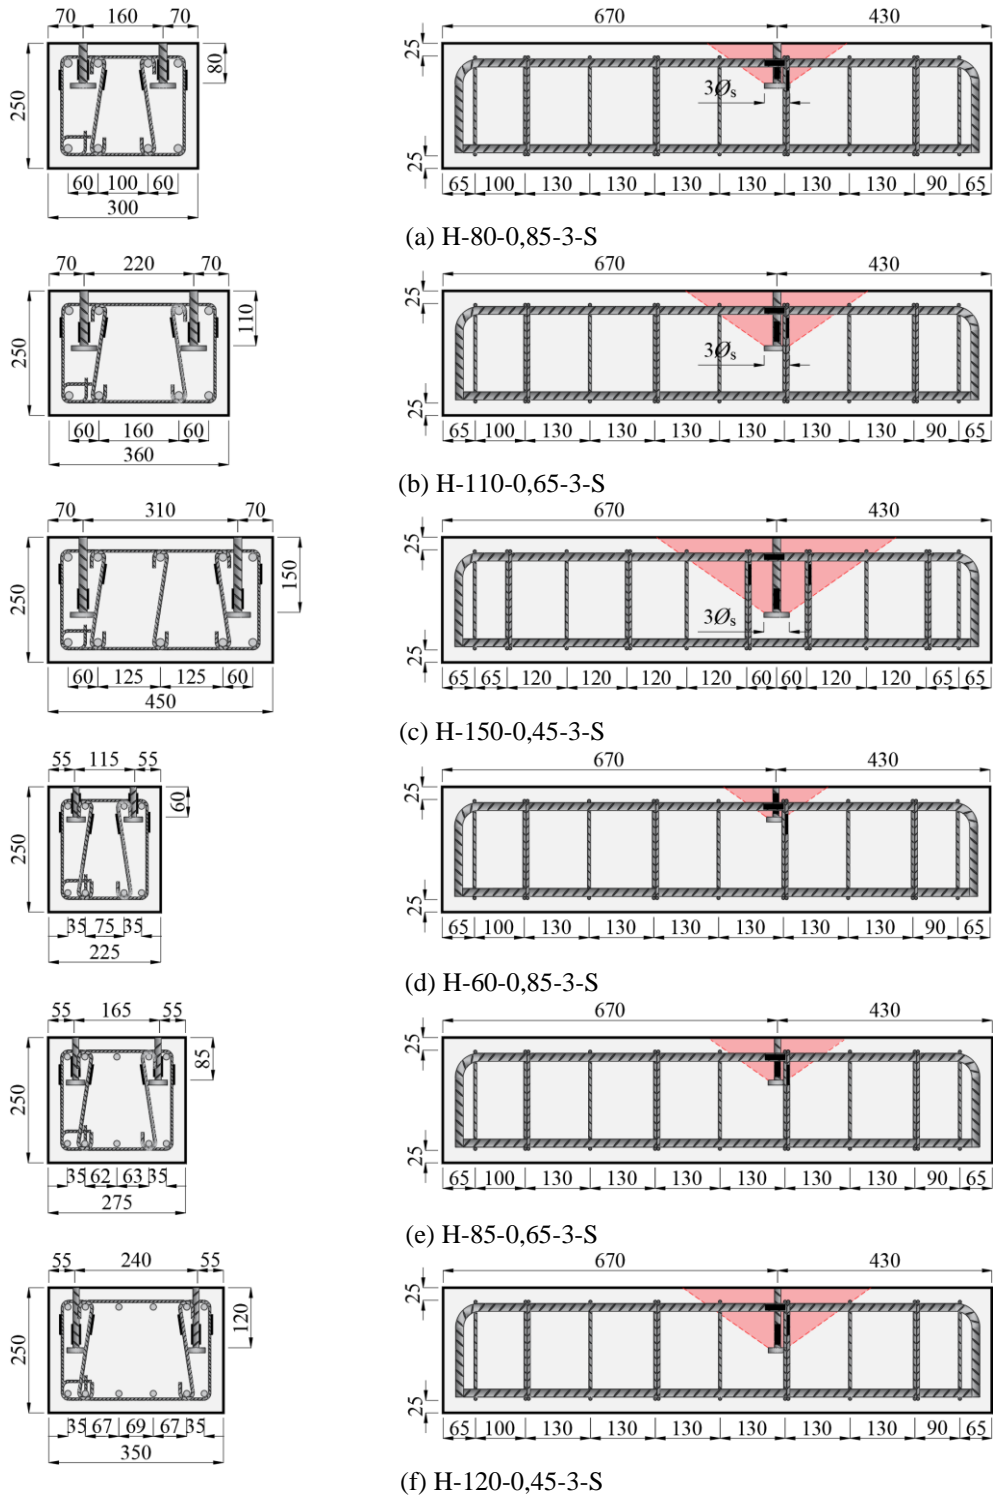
Detalhamento dos espécimes G4 – Barras com cabeça
